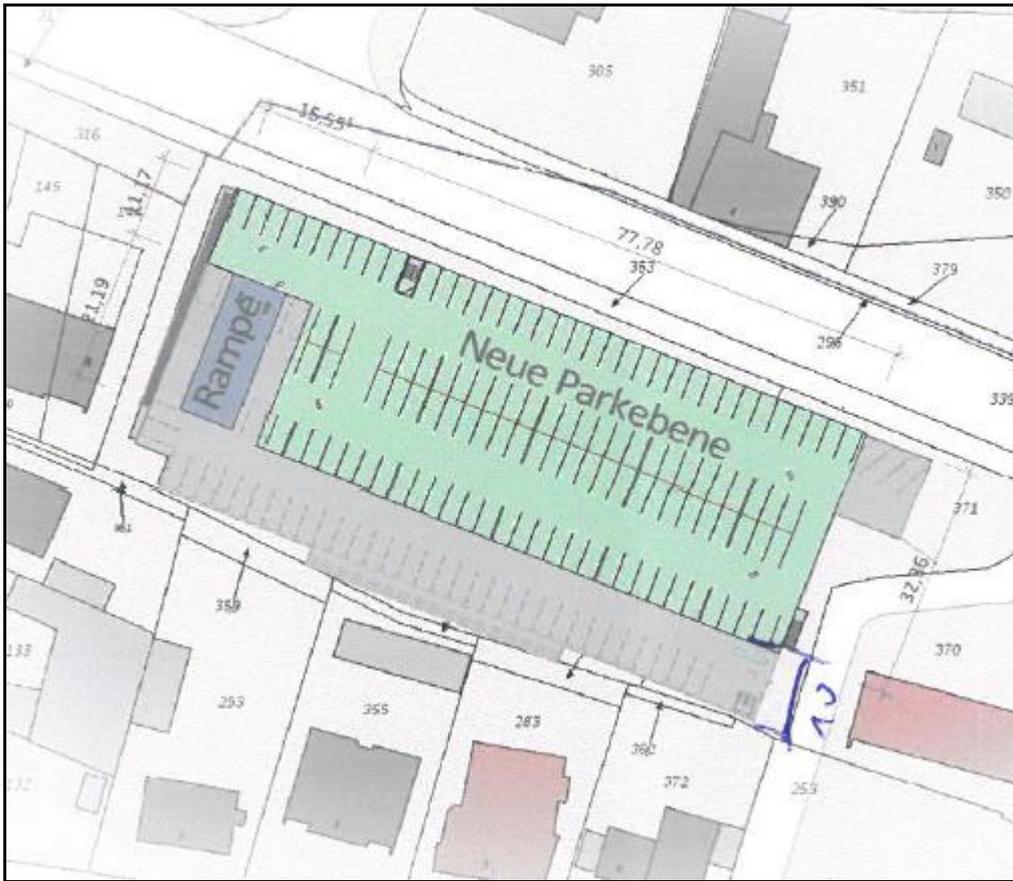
Lageplan (o.M.) der geplanten Aufstockung des Parkdecks um eine Ebene, Ingenieurbüro Schülke Wiesmann, Stand: 14.07.2017
